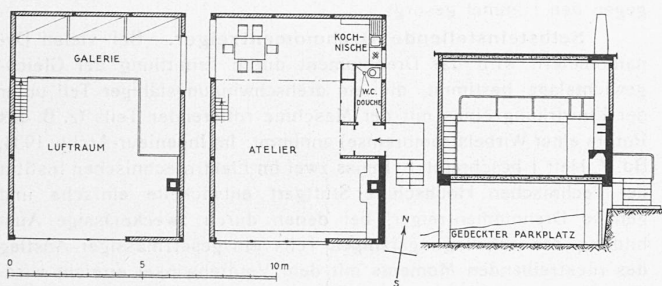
Grundrisse und Schnitt. — Masstab 1 : 250.
